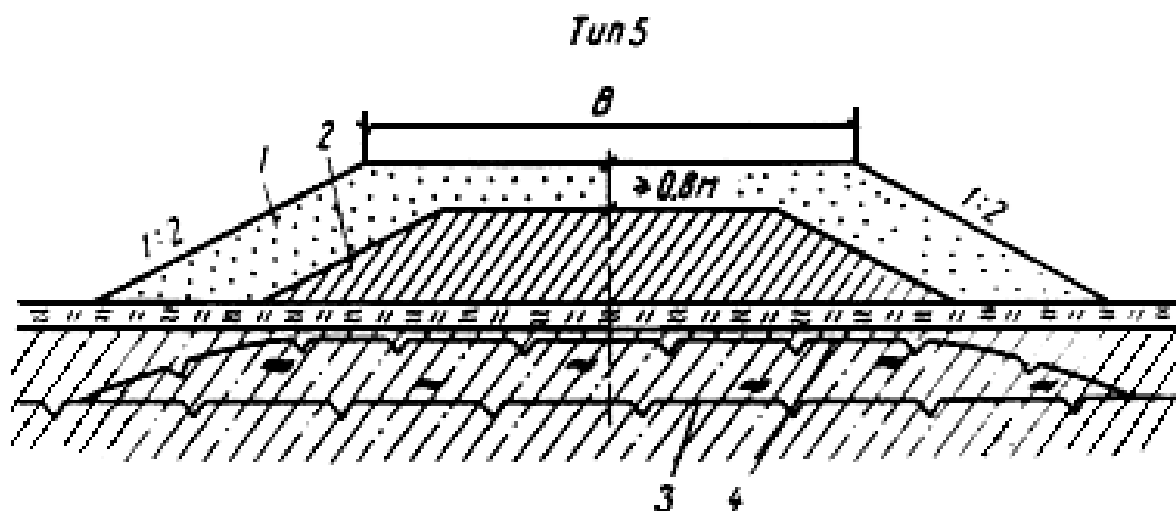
Поперечный профиль насыпи с мерзлым грунтом в нижней части:
